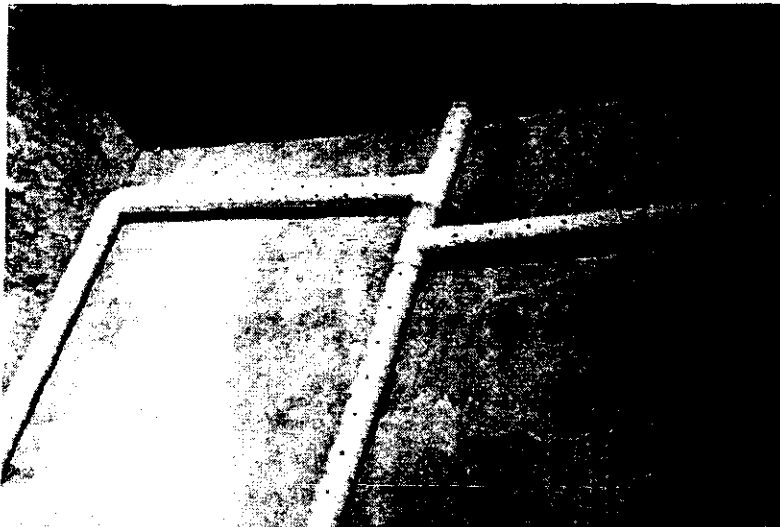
Conexión de la tubería de drenado al fondo del HAFV
